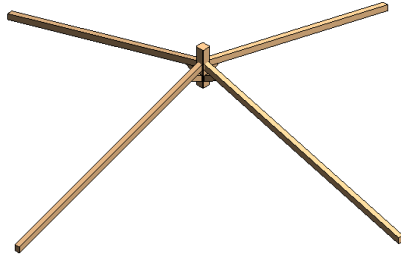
Modelado 3D de las vigas diagonales de la cubierta de la capilla. Fuente: elaboración propia
